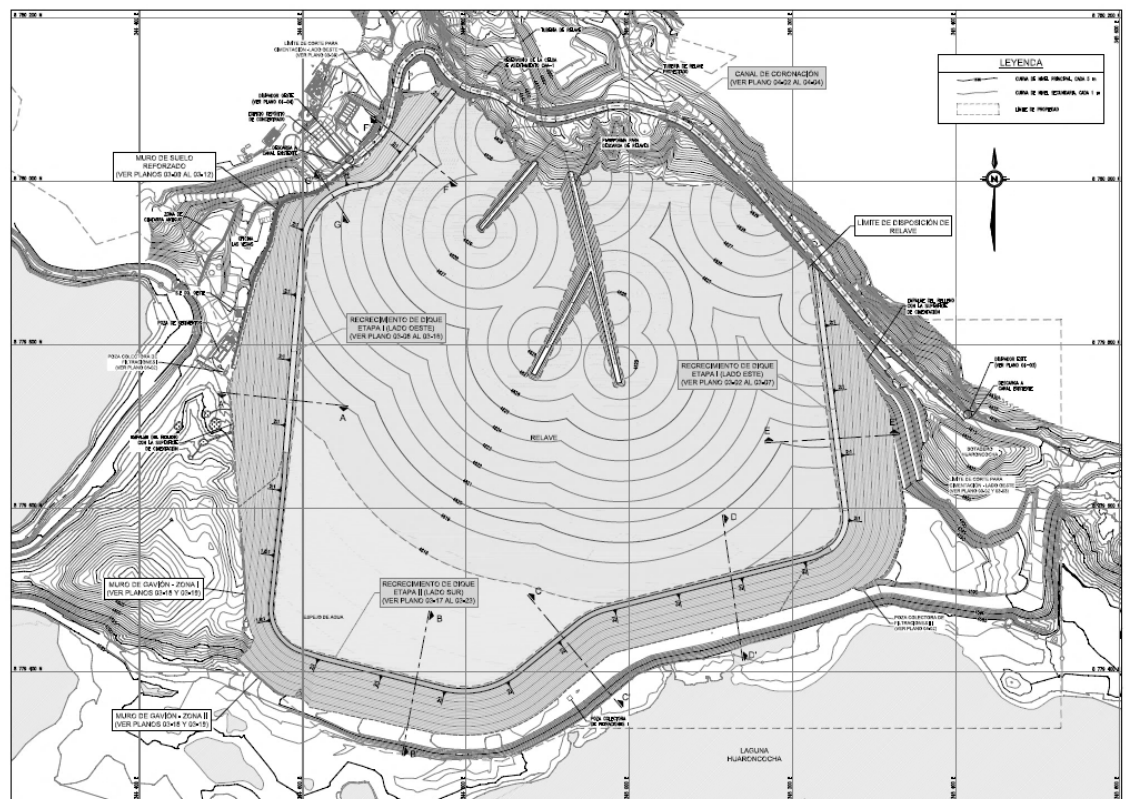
Planta general de la mina animon – Cía. Volcán zona afectada para el estudio
